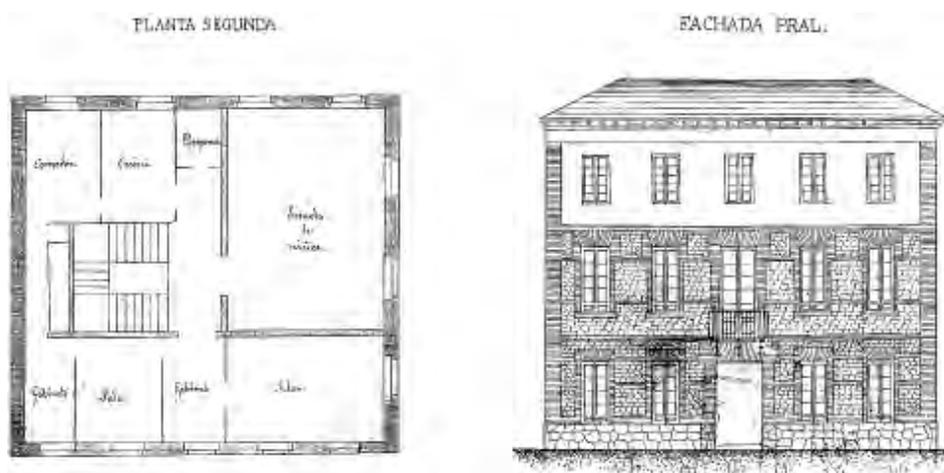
Planta segunda y fachada principal del edificio para Casa Consistorial y escuelas de Cetina, proyectado por el arquitecto Félix Navarro en mayo de 1882 (Archivo de la Diputación Provincial de Zaragoza).
